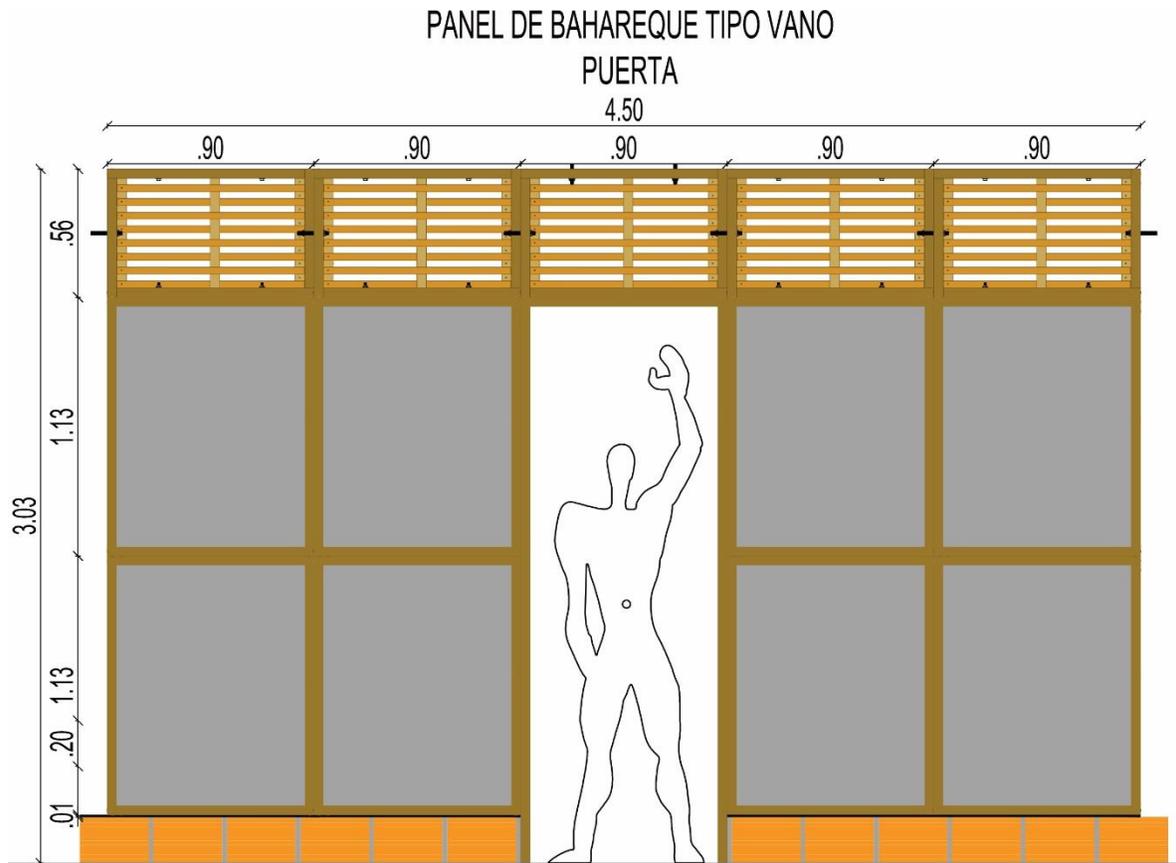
Detalle constructivo de instalación de panel sobre cimiento.
